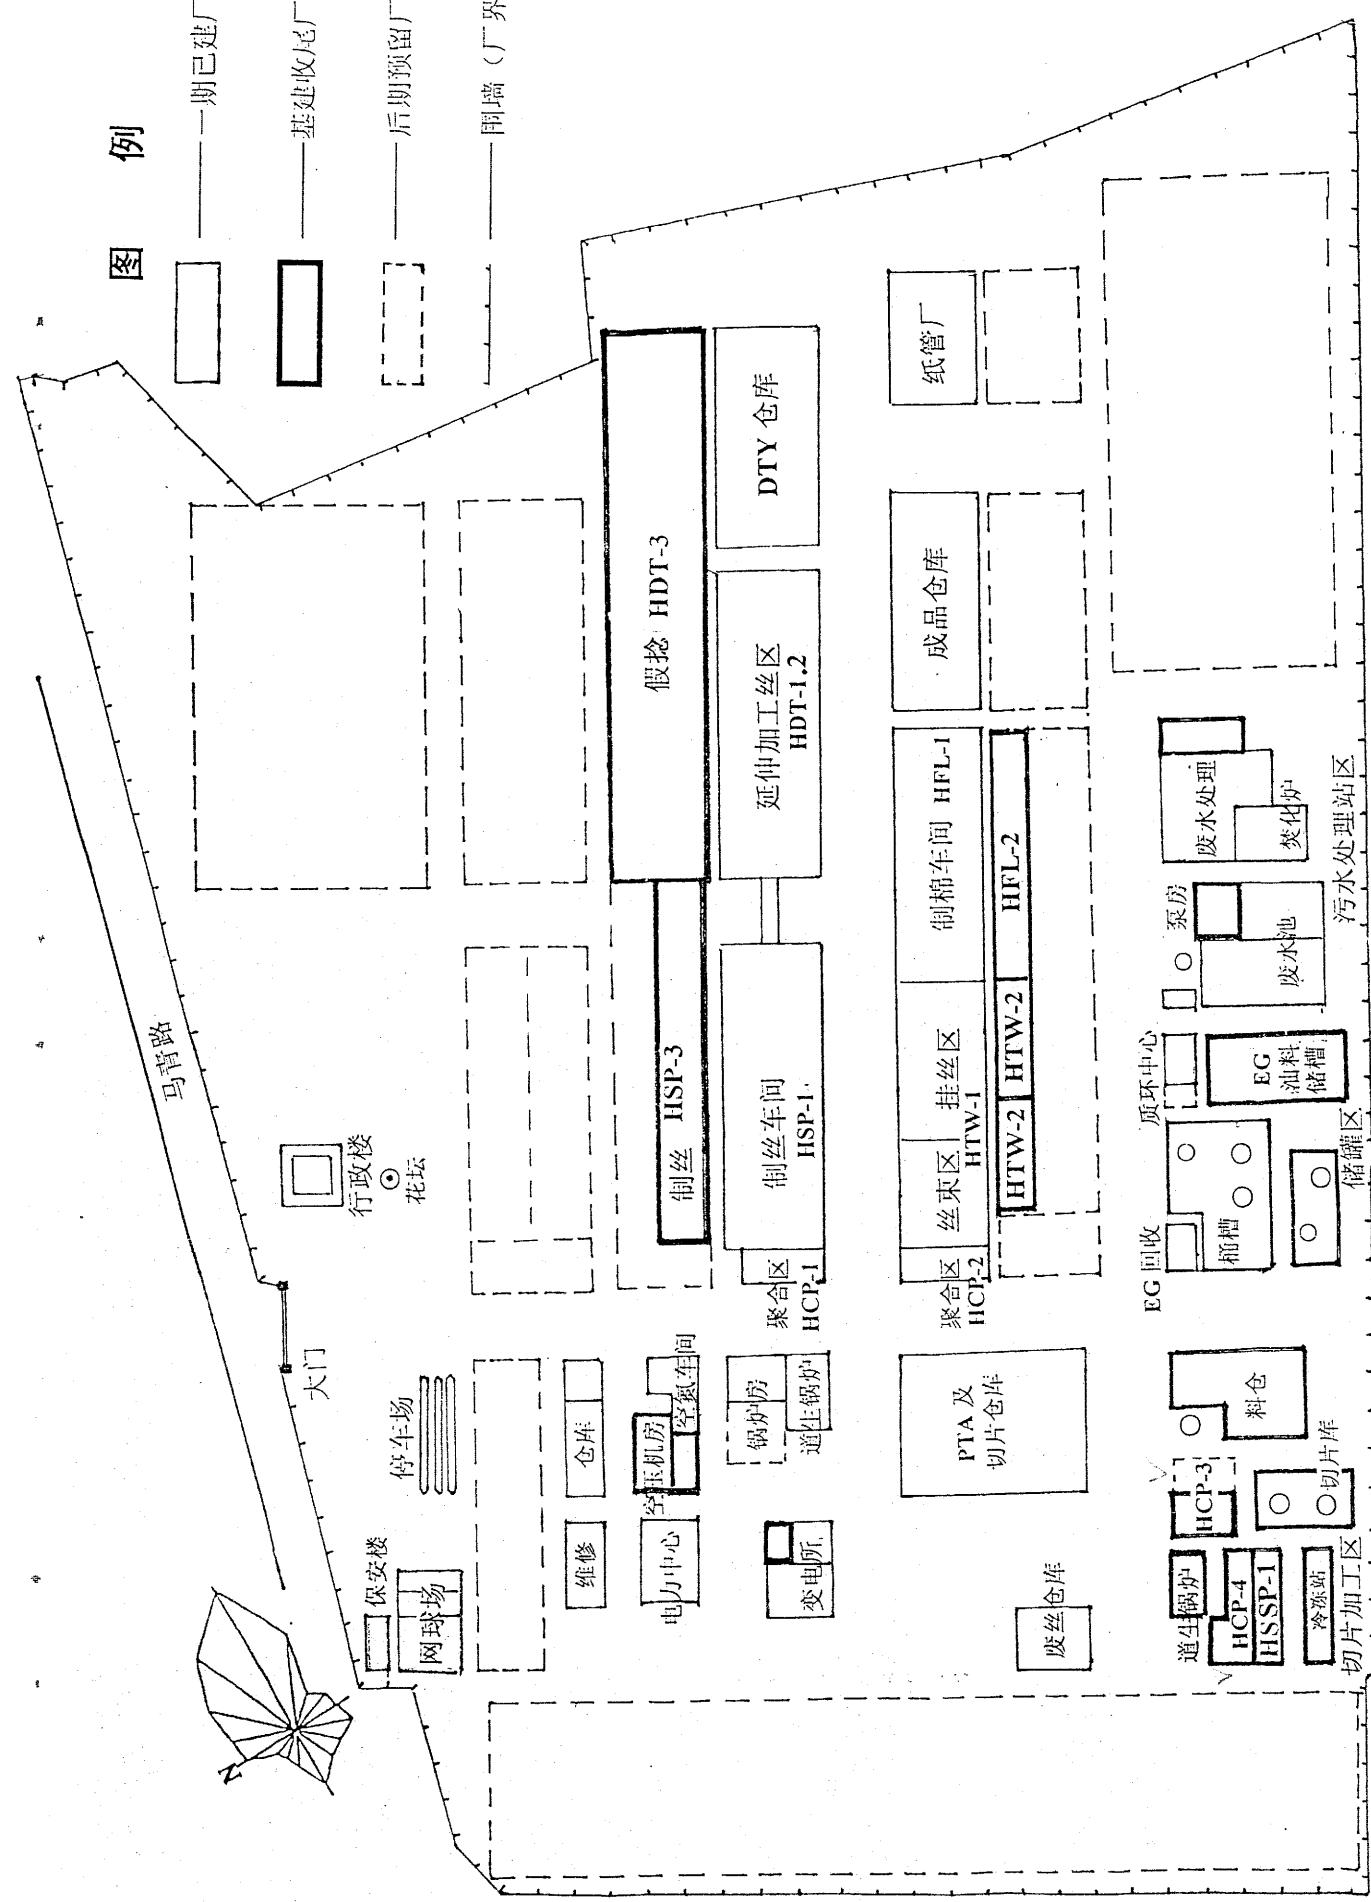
翔路涤纶纺纤(厦门)有限公司厂区平面布置图
